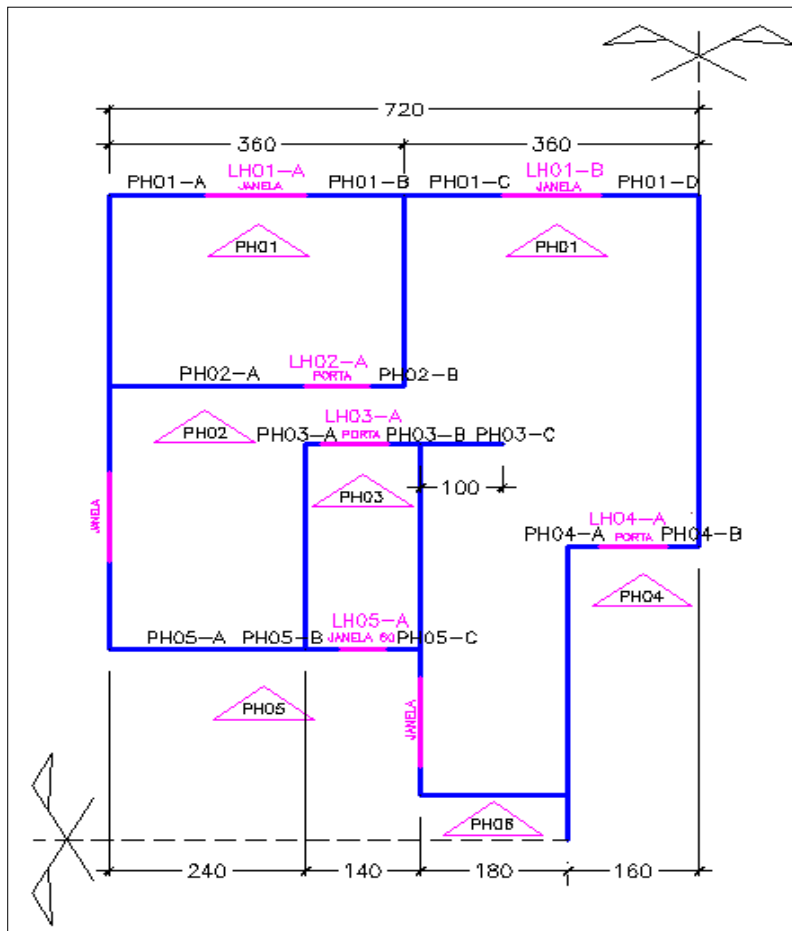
Planta baixa das paredes do edifício Colubandê 1 na direção horizontal.
